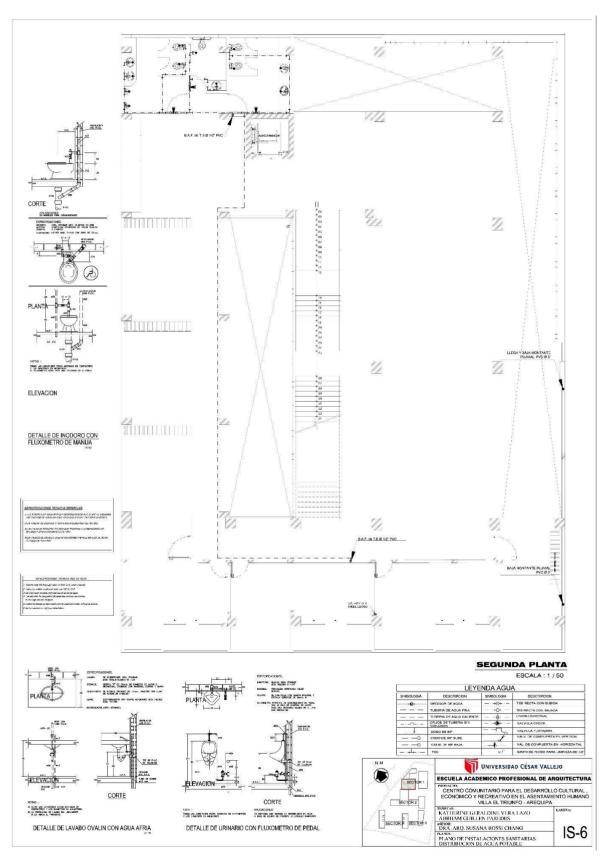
Planos de distribución de redes de agua potable Segunda Planta - Elaboración propia
